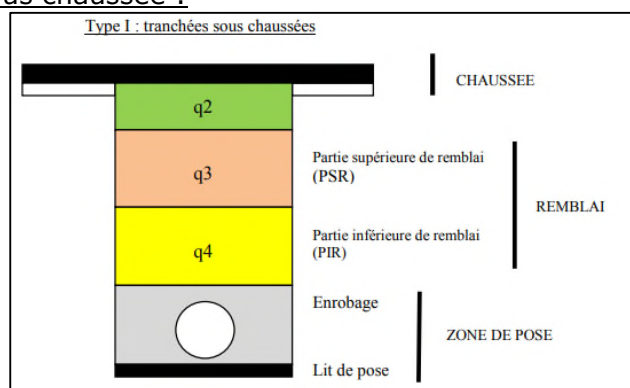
Schéma détaillé d'une tranchée de type I : tranchée sous chaussée
